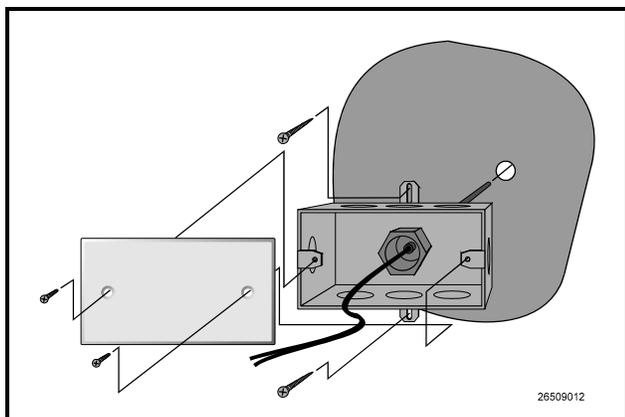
Montaje de la Sonda de Inmersión de 12"
